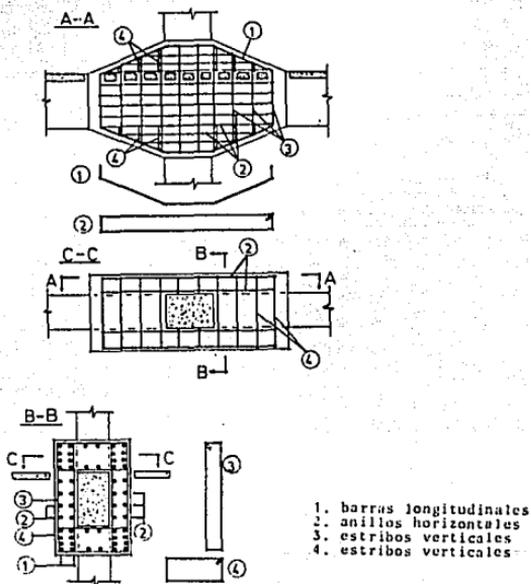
Encasado local de un nudo de concreto reforzado.
